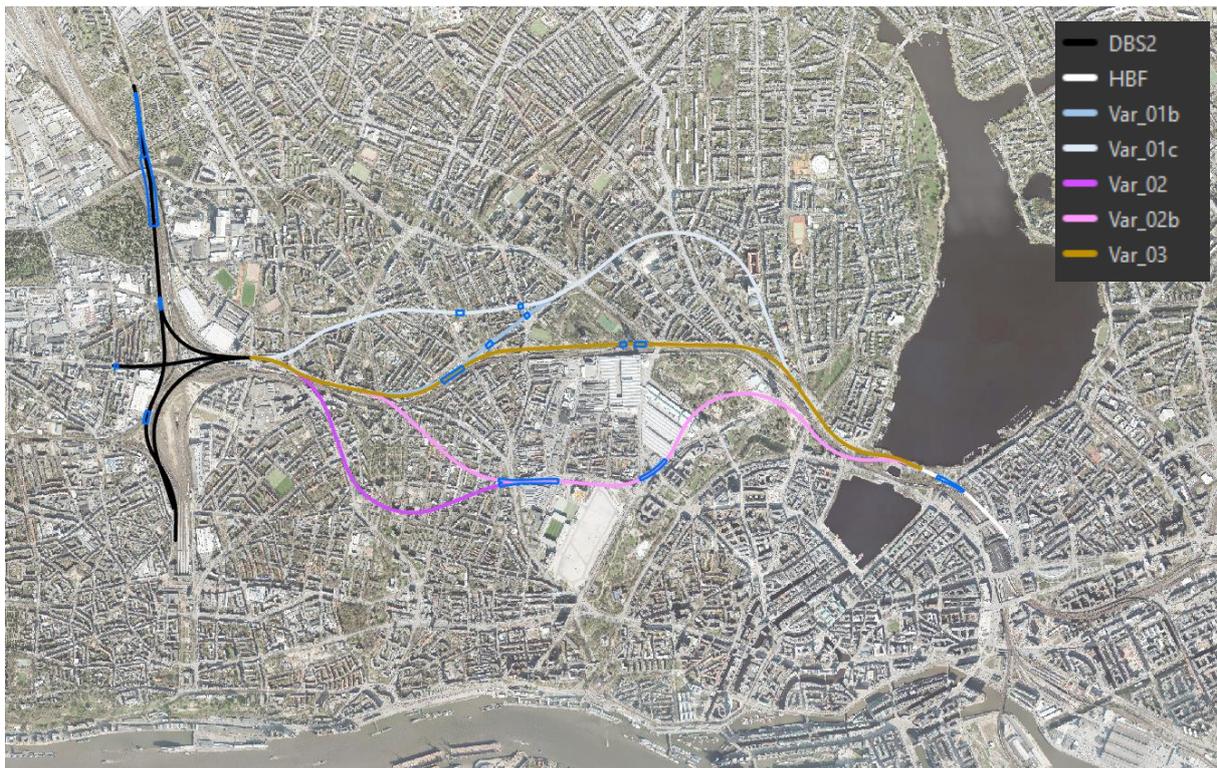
Übersicht der Abschnitte mit offener Bauweise des Tunnels (blau). Luftbild: DOP20 - Freie und Hansestadt Hamburg, Landesbetrieb Geoinformation und Vermessung (LGV).
